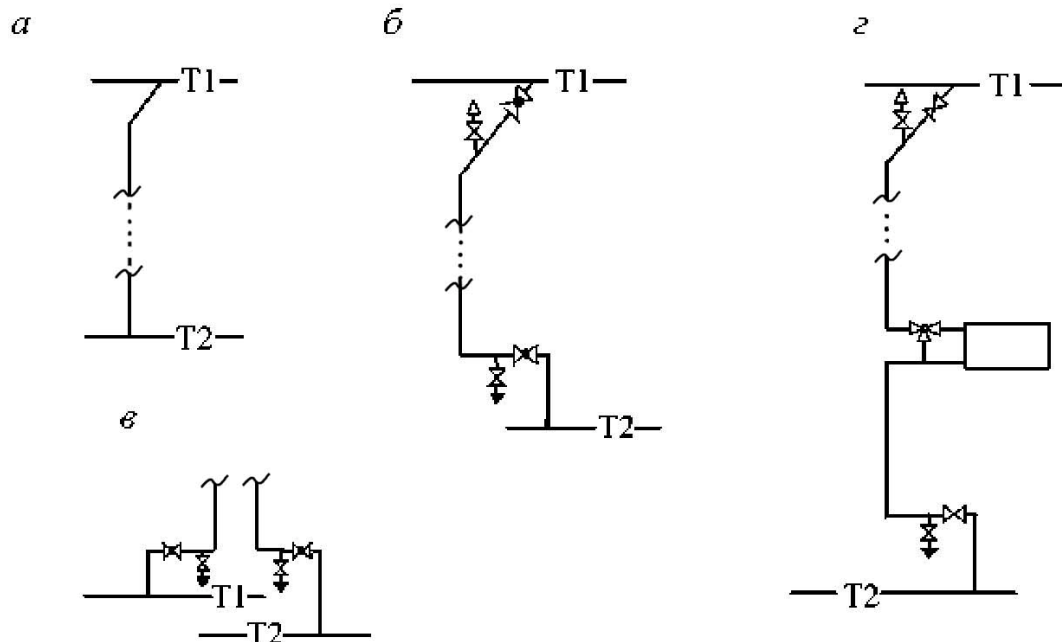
Схемы присоединения стояков к магистралям систем отопления двух-, трехэтажных зданий (а), четырех-, семиэтажных при верхней разводке (б) и при нижней разводке (в), восьмиэтажных и более высоких зданий (г)
